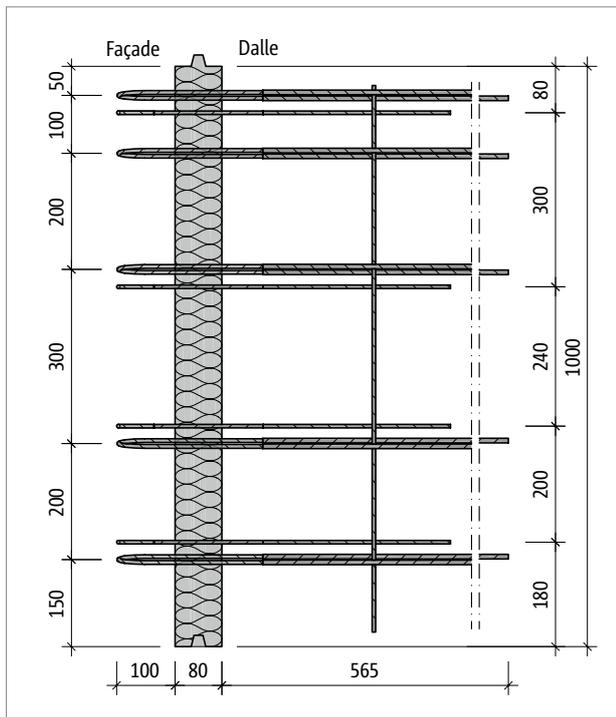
Schöck Rutherma® T type DF-V3-LR100 : vue en plan du produit
